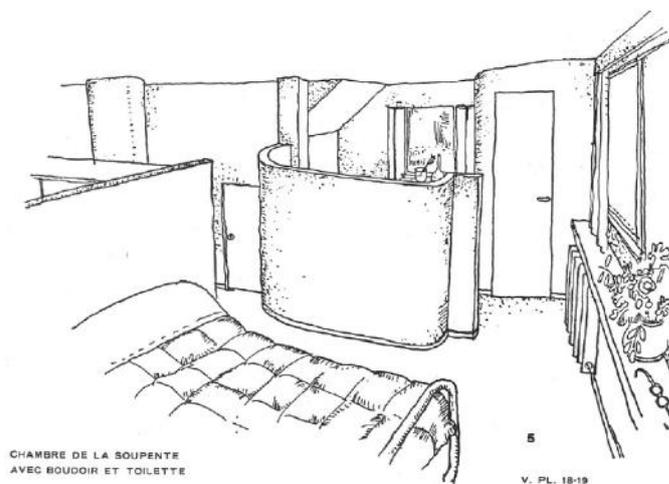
Vista del dormitorio principal y el baño, ubicados en la planta segunda.
